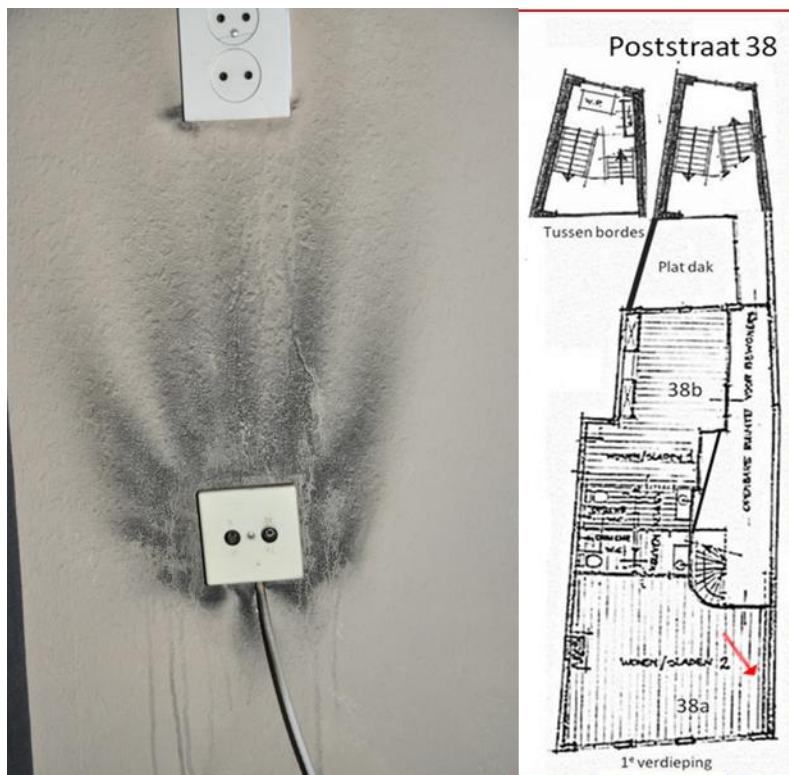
, rookverspreiding uit wandconstructie appartement nr. 38a
